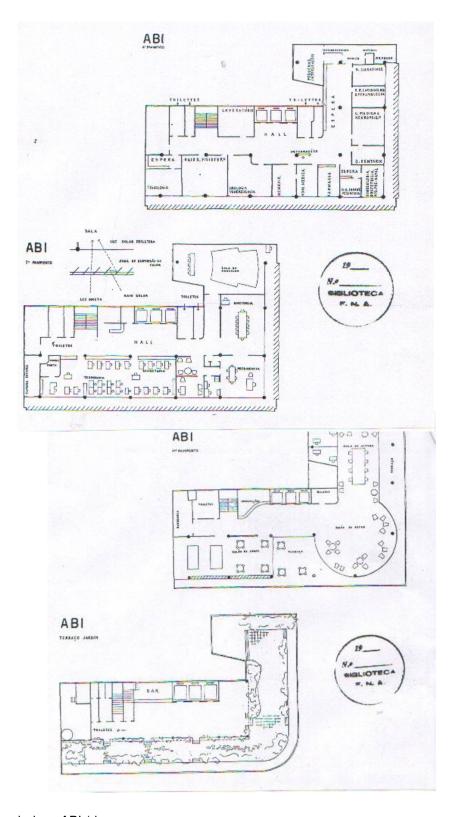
plantas baixas ABI (de cima para baixo: 4º pav., 3º pav. [diretoria], 11º pav. [salas jornalistas], terraço jardim)
